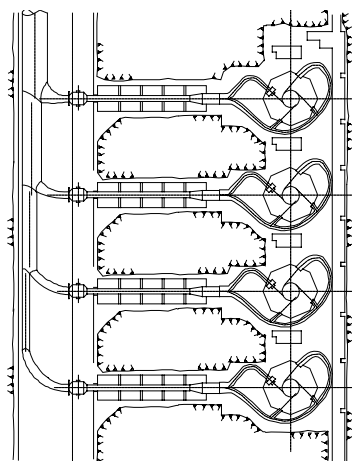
Planta da casa de válvulas, casa de força e área de montagem – Turbina Pelton.
